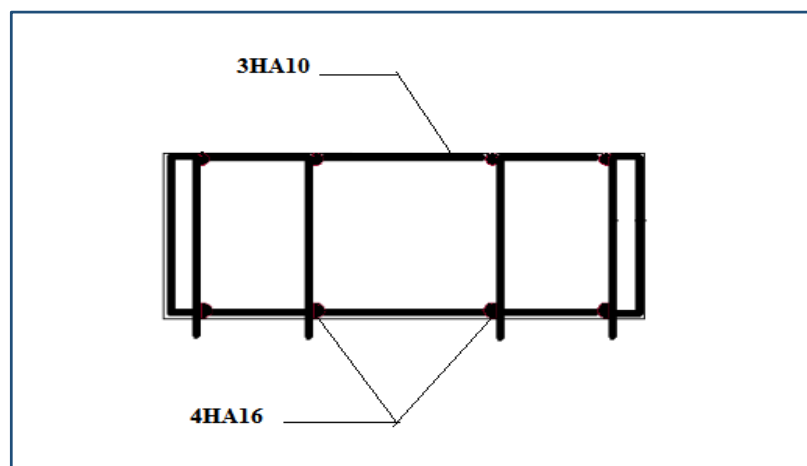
Schéma de ferrailage de la dalle de transition selon x.
